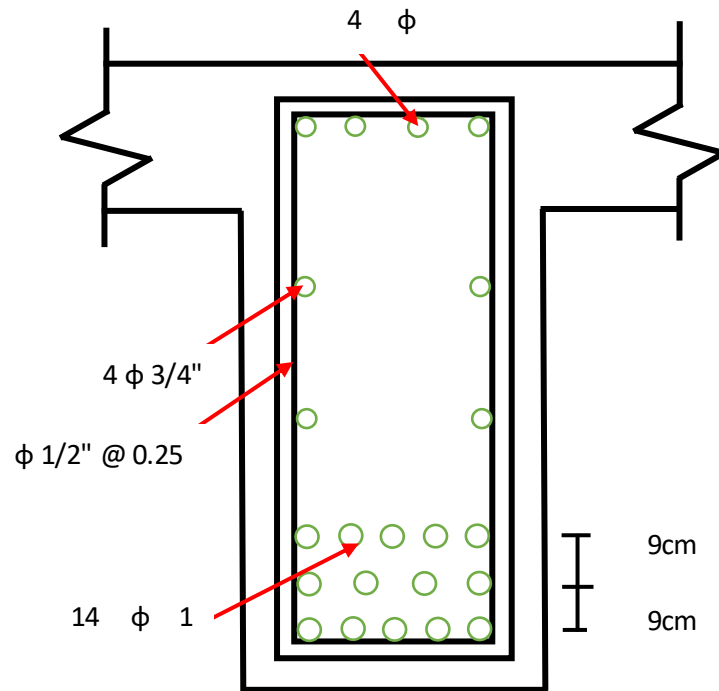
SECCION DE LA VIGA-FUENTE: ELABORACION PROPIA
